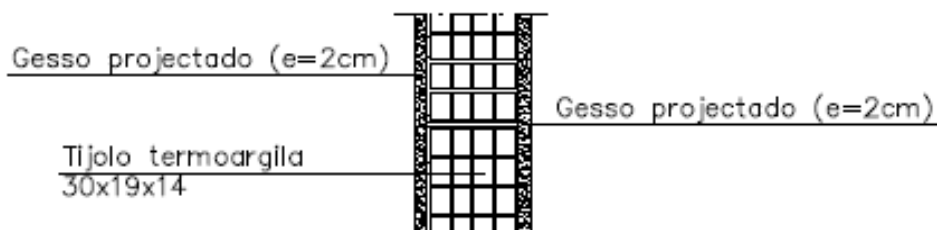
Pormenor construtivo da parede interior de separação do espaço comercial com a entrada da fração T2 (Projeto de CT)
